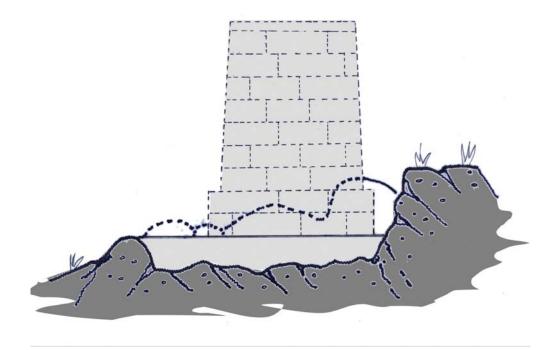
Cimentación directa en roca con excavación horizontal.
